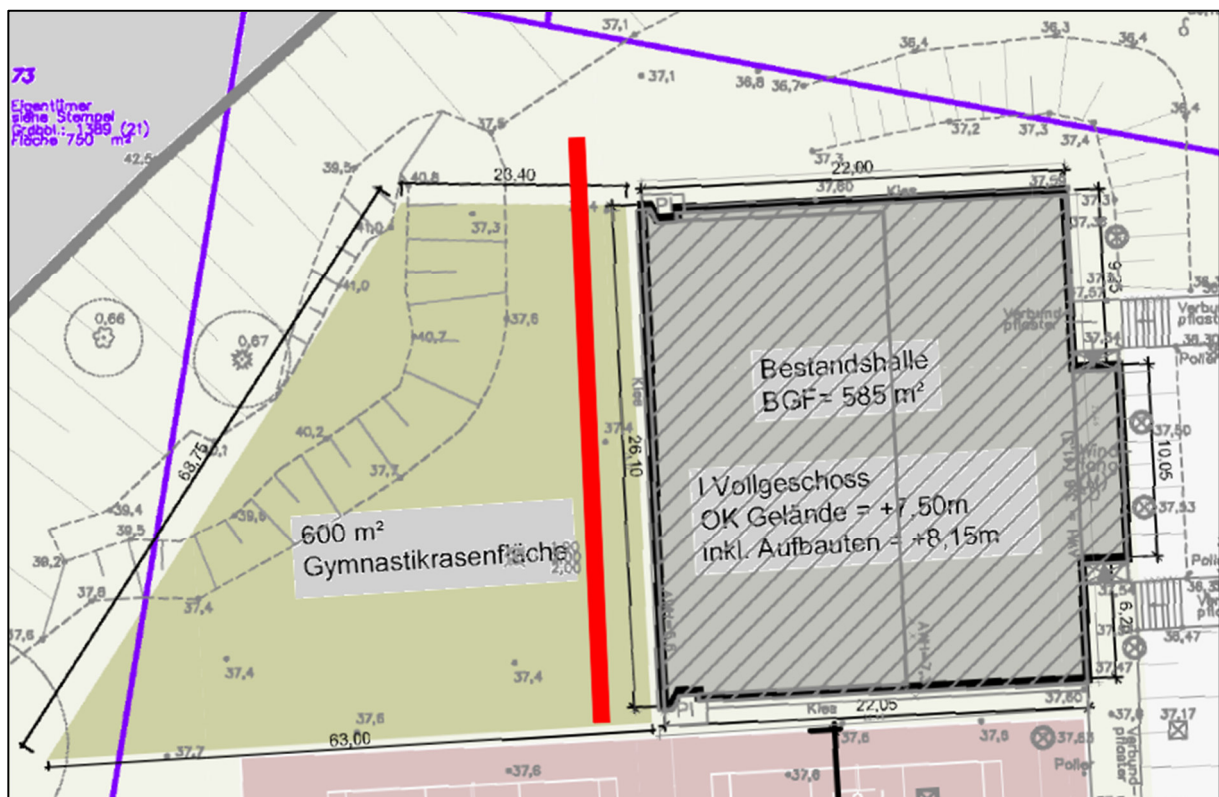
Lage Rigole Dachflächen – Bestandshalle Außenanlagenplanung Variante 2
